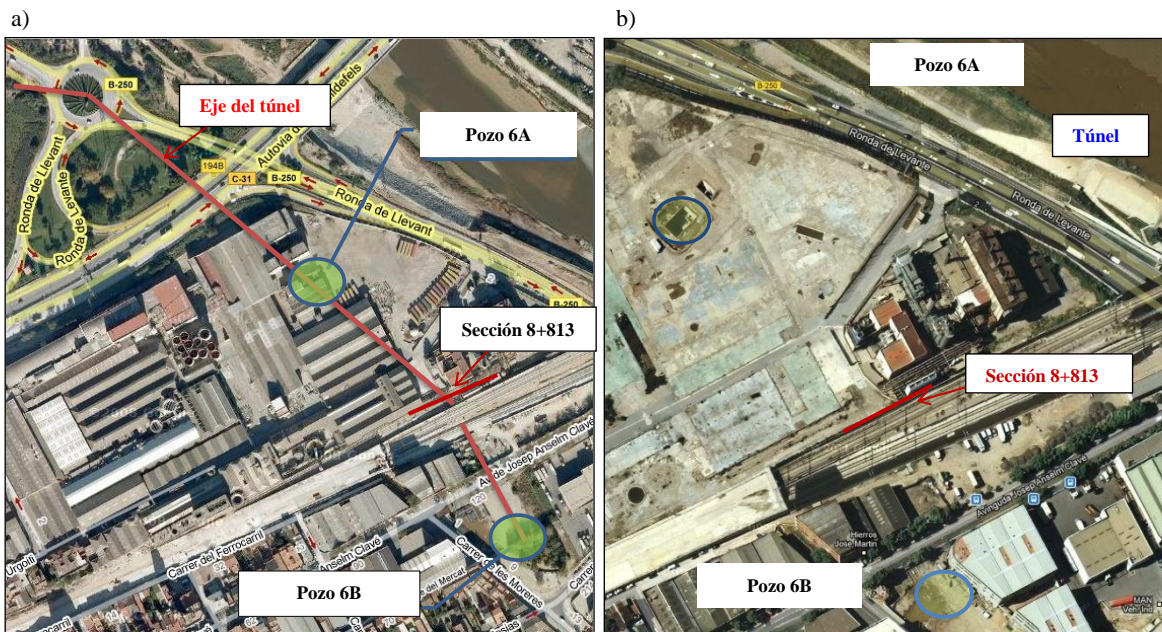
42. a) Vista desde satélite en alzado b) Vista desde satélite en planta, sección T1E PK 8+813. Fuente: Google Maps
